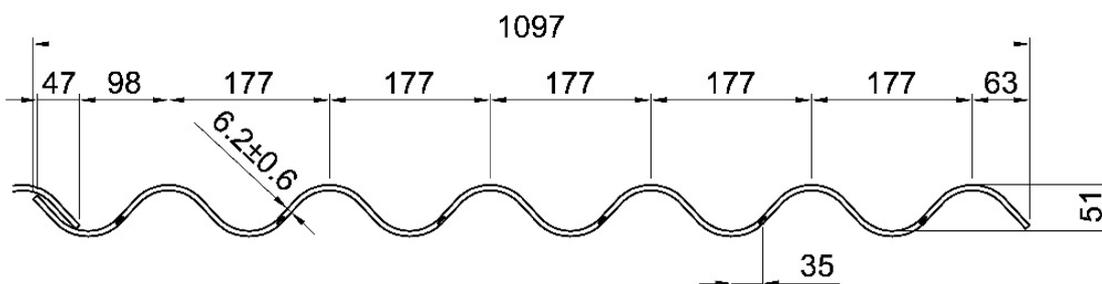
Wellplatte Profil P6 mit 6 Wellen
